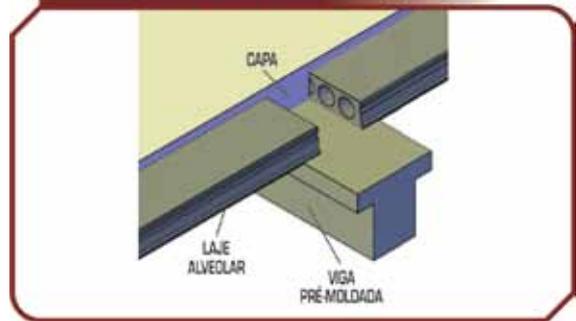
Ligação Laje Alveolar – Viga – Capa
